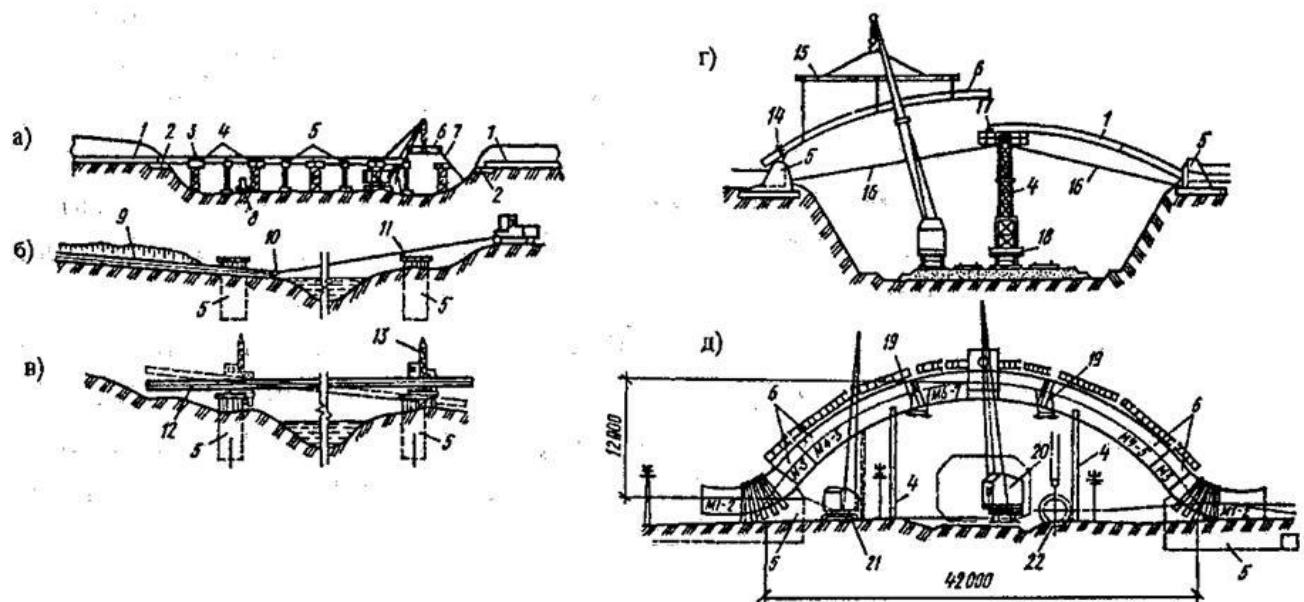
Монтаж балочных и арочных самонесущих трубопроводов
